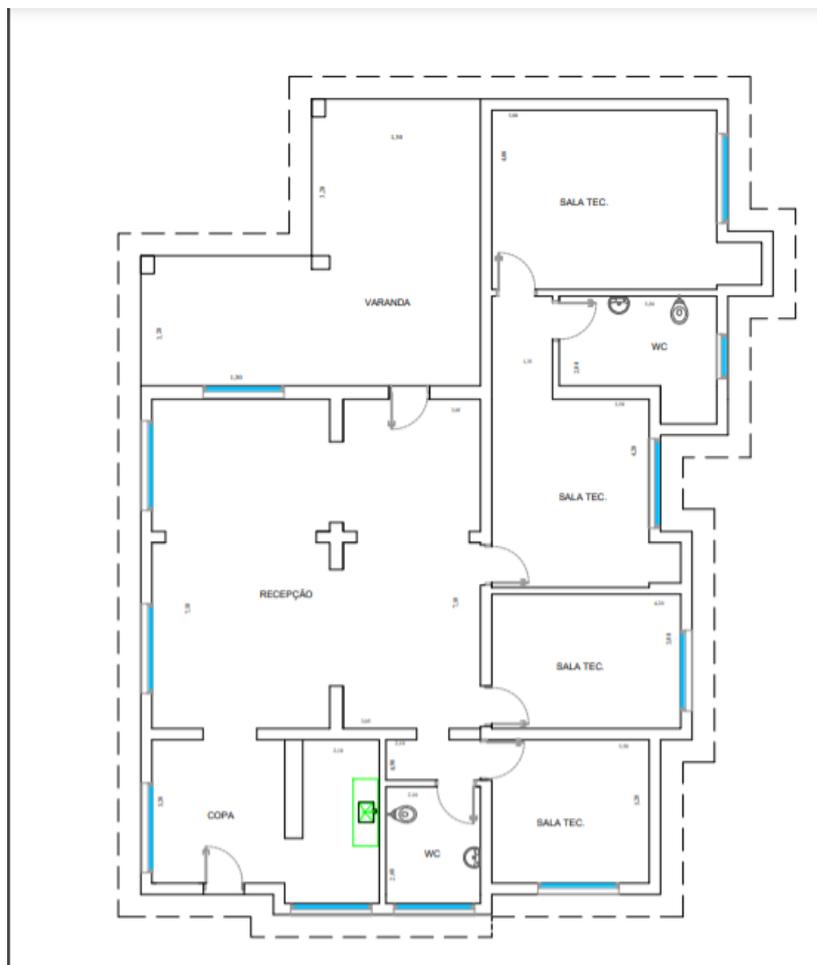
Planta Baixa do Espaço de geração de empreendimentos no Instituto Biológico – IB.
